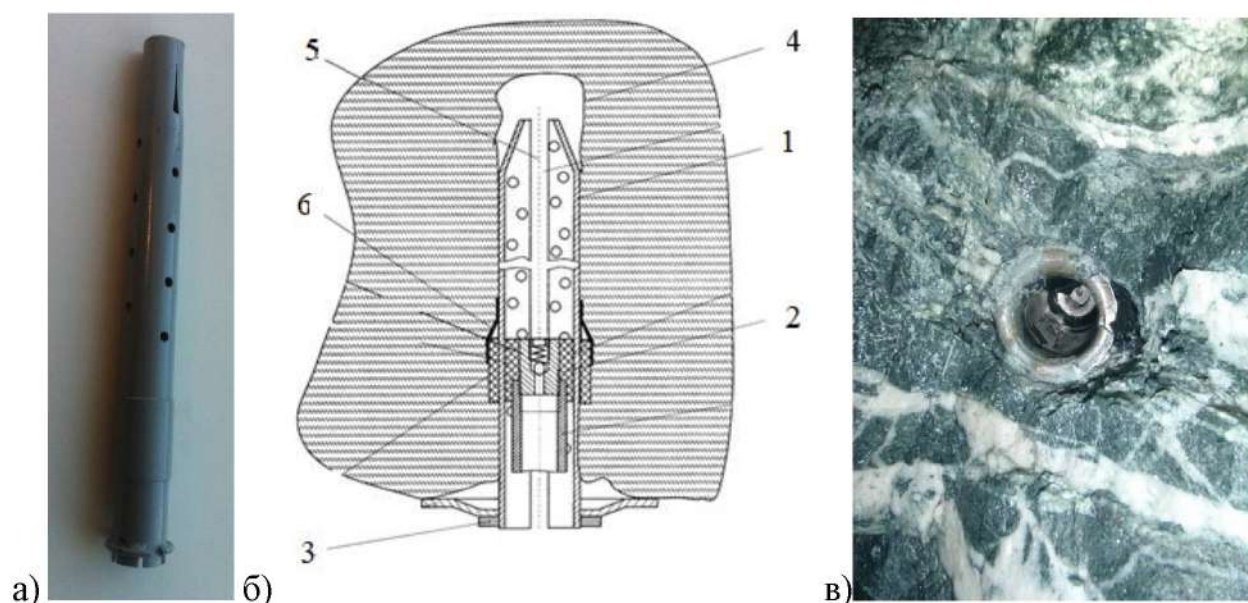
Конструкция СЗА-инъектора: а — общий вид; б — конструктивная схема: 1 — перфорированная труба, 2 — запорное приспособление, 3 — опорная плита, 4 — шпур, 5 — продольный паз, 6 — металлический кожух; в — установленный в шпуре горной выработки.
